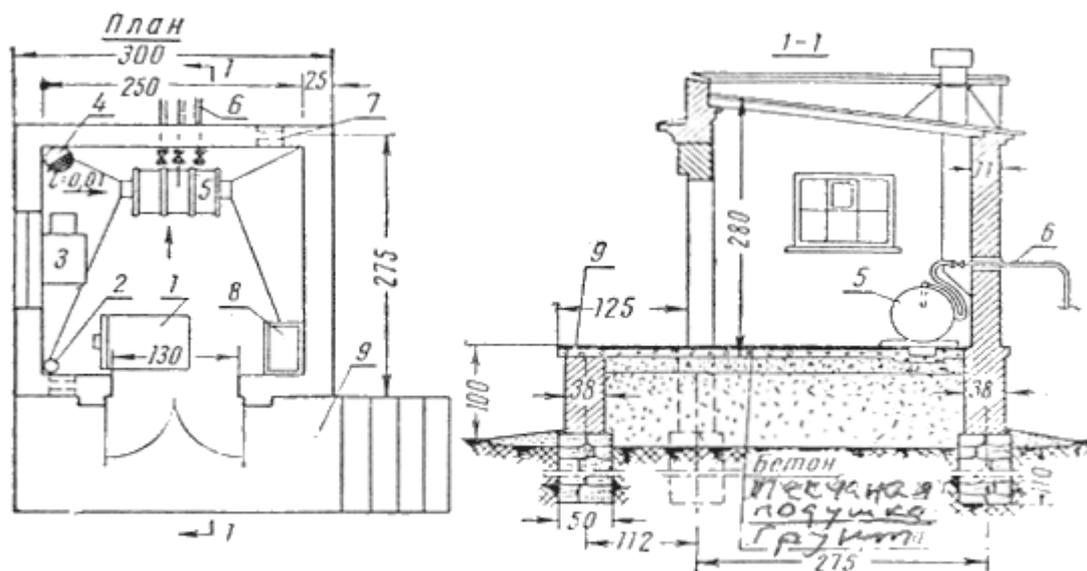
Схема помещения разливочной для затаривания нефтепродуктов: 1-весы напольные (заглубленные); 2- огнетушитель; 3-рабочий стол; 4-вентиляционный канал; 5-бочка; 6-трубопровод для подачи нефтепродуктов; 7- вентиляционные отверстия; 8-ящик с песком
